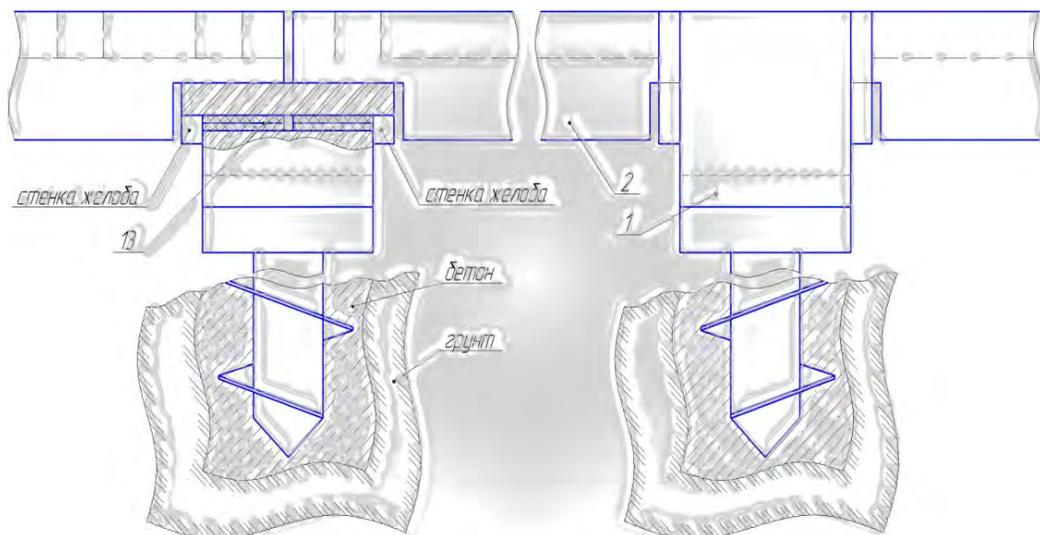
Фронтальный вид предлагаемого ЛРТ-пути: 1 – монолитная свайная опора, 2 – лежневый путь сборно-рамной конструкции, 13 – парные эластичные опорные элементы [выполнено авторами].
